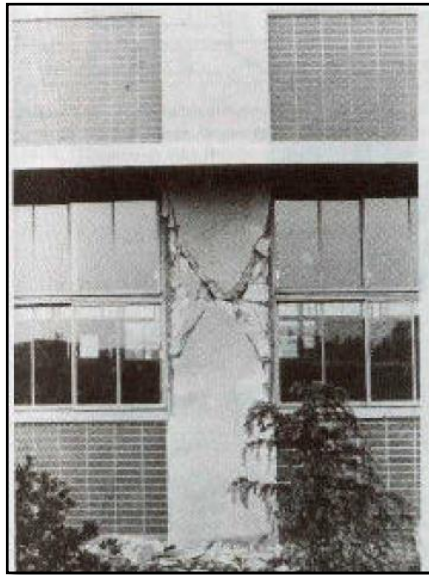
Fallas por Cortante en Columnas de Concreto Armado.
